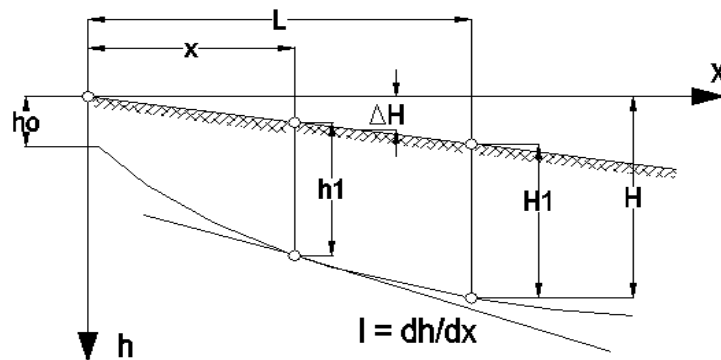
Determinarea elementelor din profilul longitudinal
